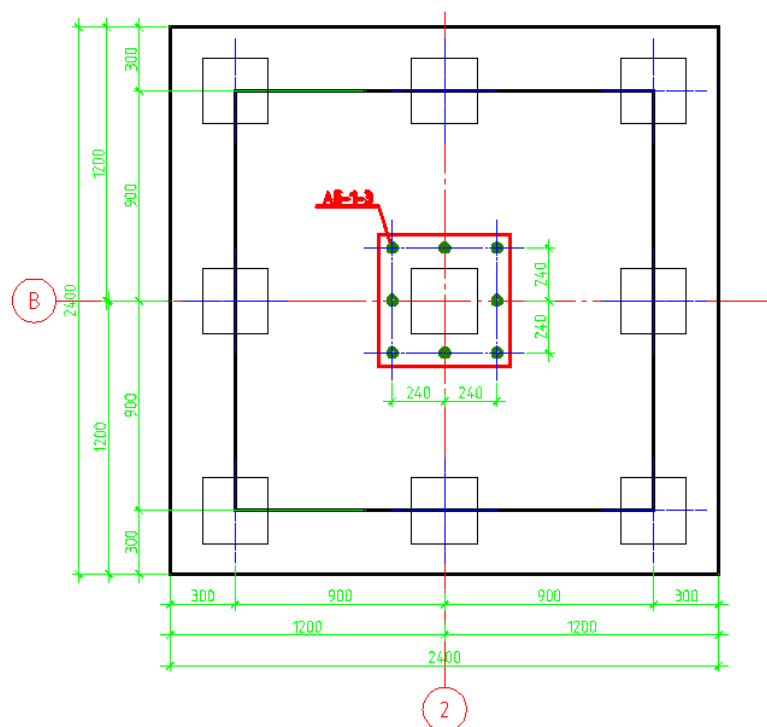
Схема расположения свай в наиболее нагруженном фундаменте
